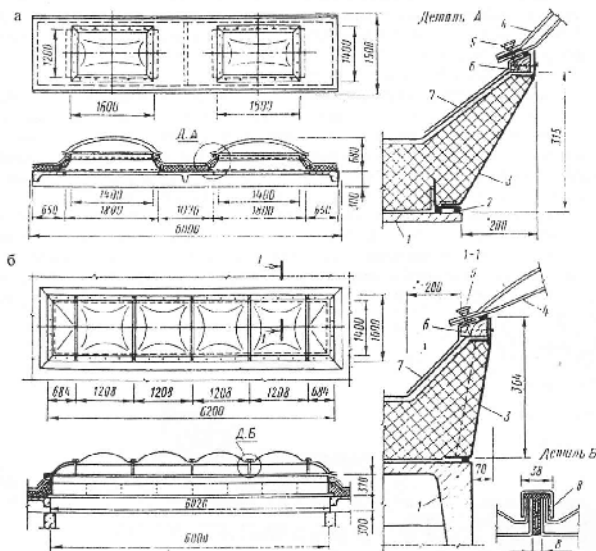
Типы зенитных фонарей из органического стекла: а – точечный; б – панельный; 1 – плита покрытия; 2 – герметик; 3 – стальной стакан; 4 – двухслойный купол из органического стекла; 5 – колпачок; 6 – опорная деревянная рама; 7 – оцинкованная кровельная сталь; 8 – накладка из оргстекла
